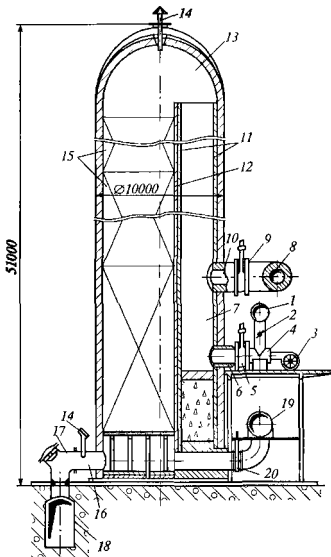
Общий вид воздухонагревателя с внутренней камерой горения
